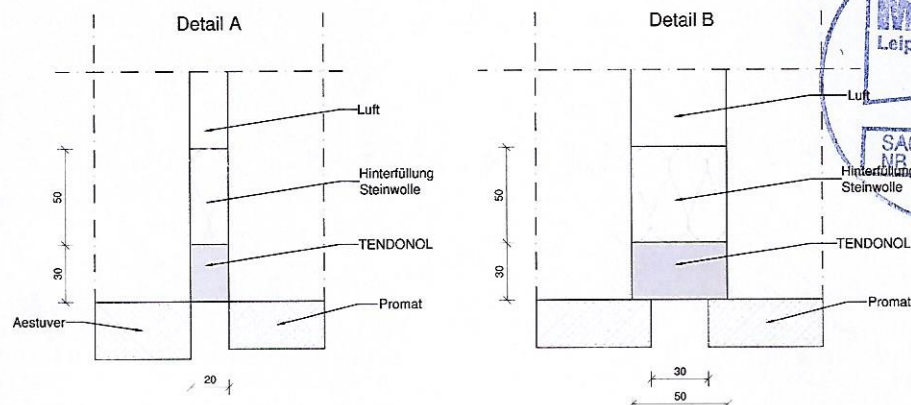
Detailzeichnungen der Beton-Bauteilfugen
